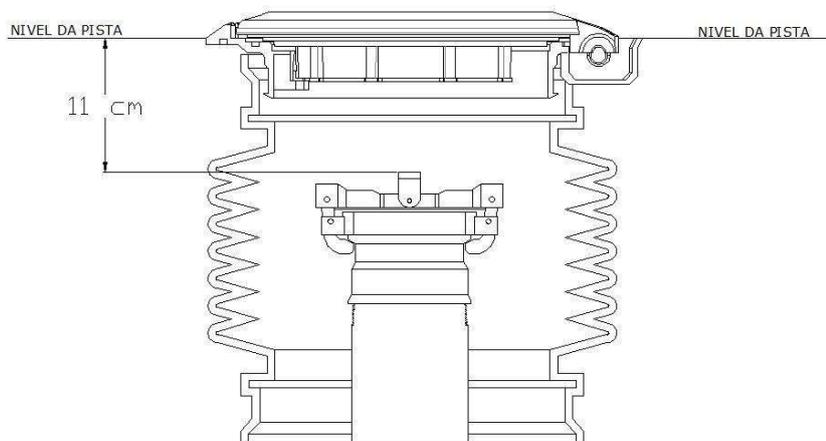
Tampa SmartSeal - Distâncias para montagem
